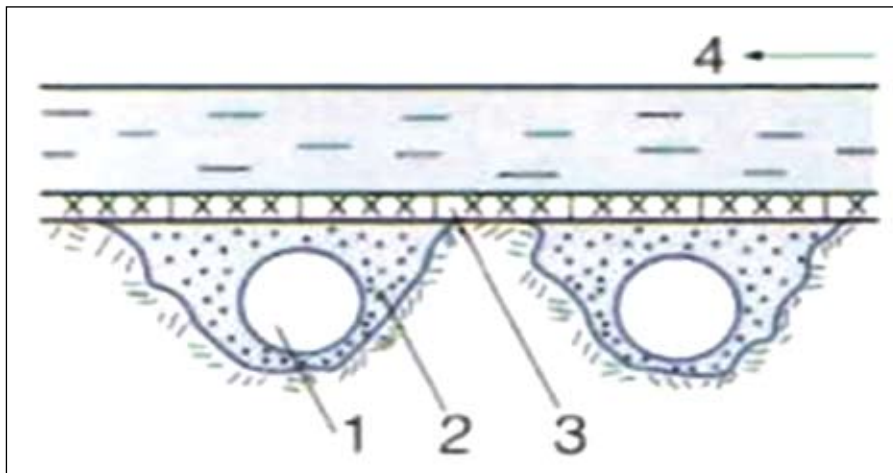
Схема крепления подводных траншей габионами: 1 – трубопровод; 2 – грунт вокруг трубопровода; 3 – габионы; 4 – уклон реки
